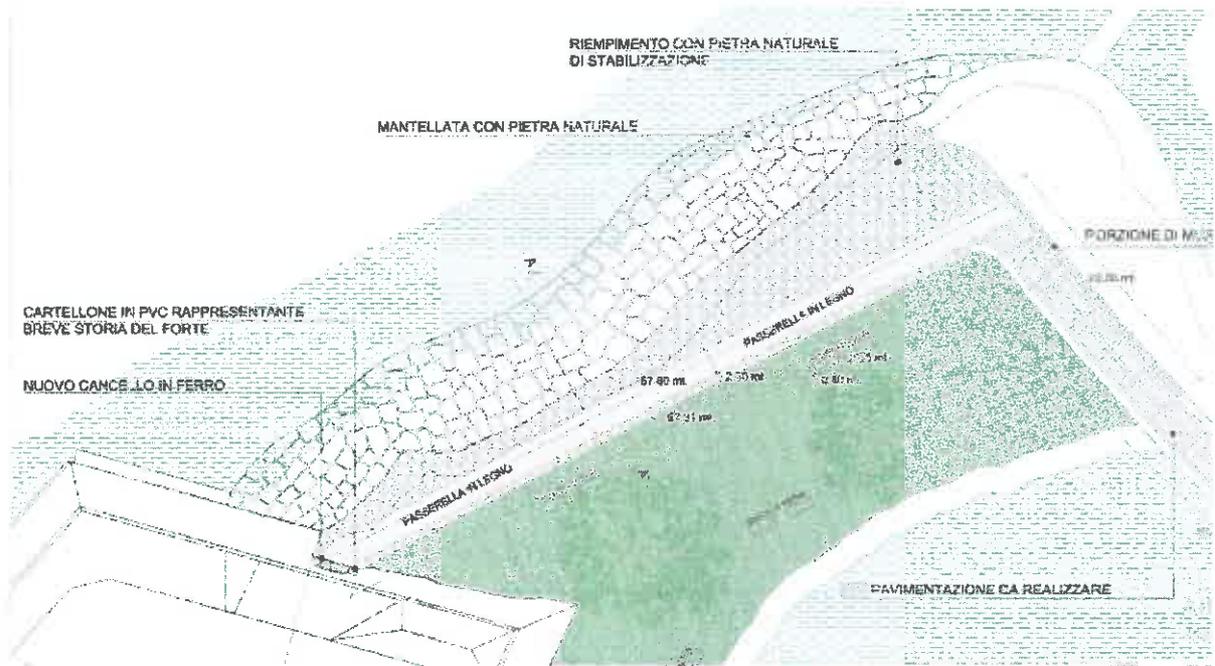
Planimetria di progetto con indicazione della mantellata da realizzare nelle aree antistanti l'ingresso del Forte Garcia.
